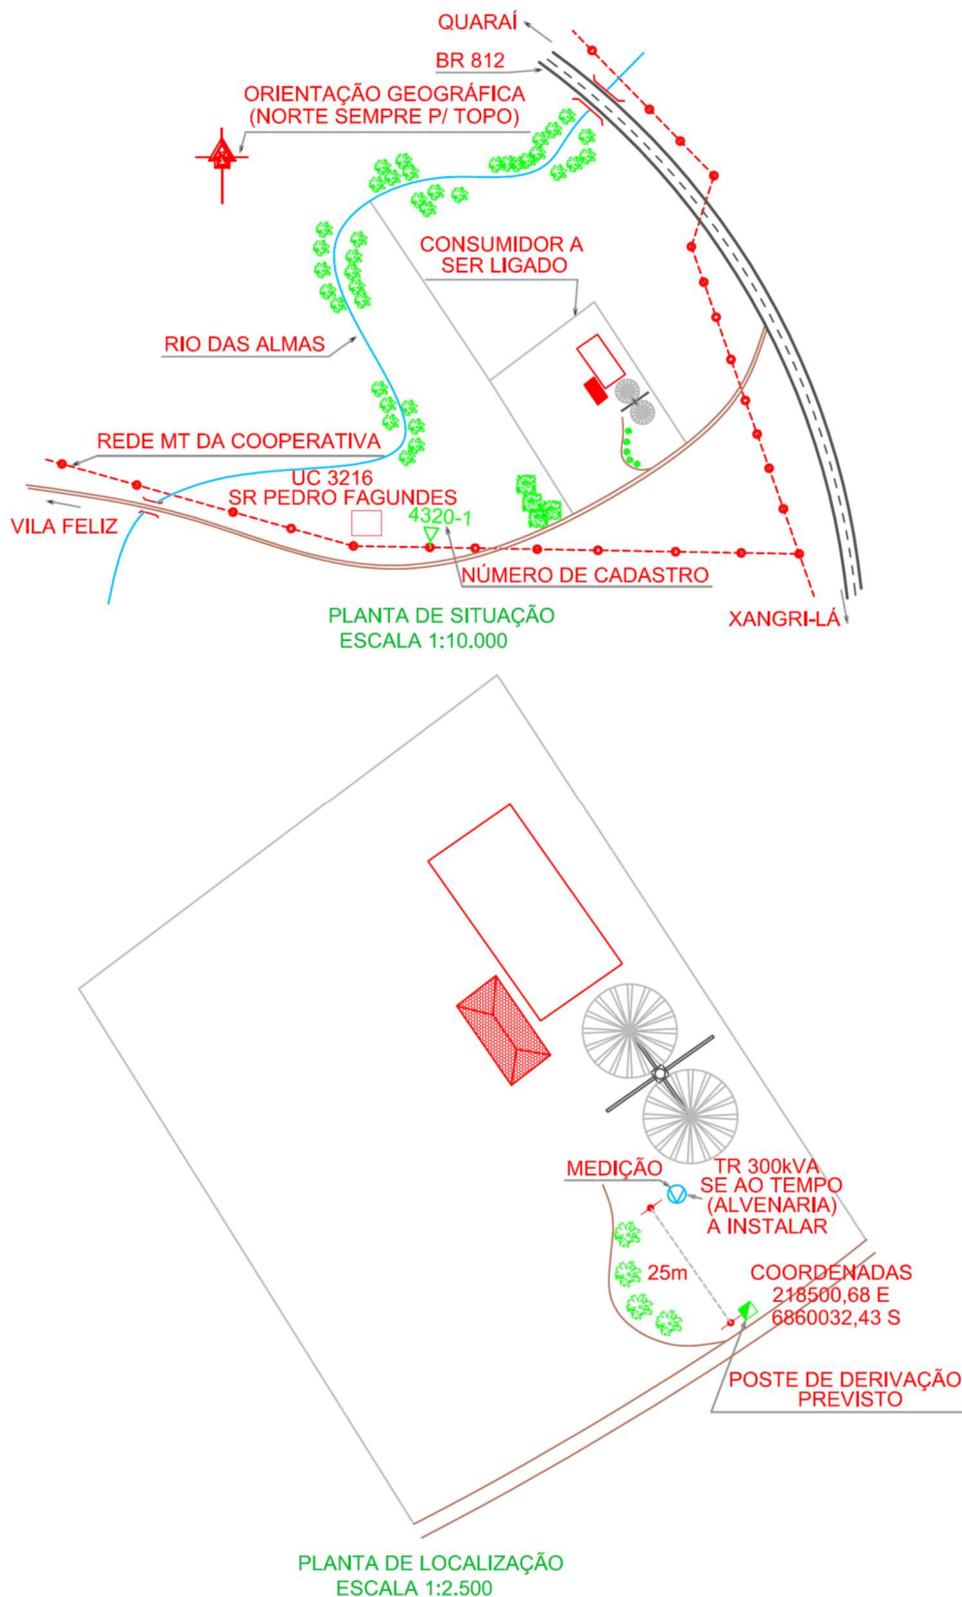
Planta de Situação e Planta de Localização em Área Urbana
